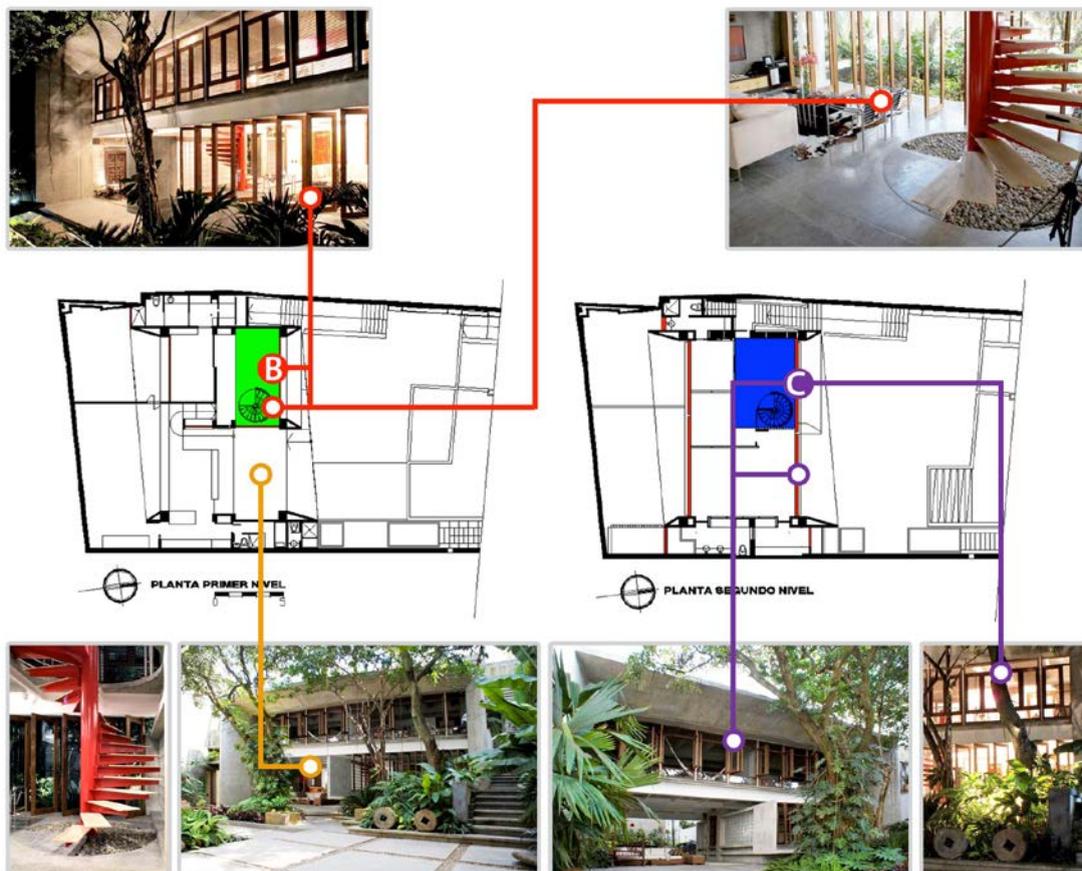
4 Planta general y fotografías “El Nispero”. Fuente: Planos Cadavid Arquitectos
